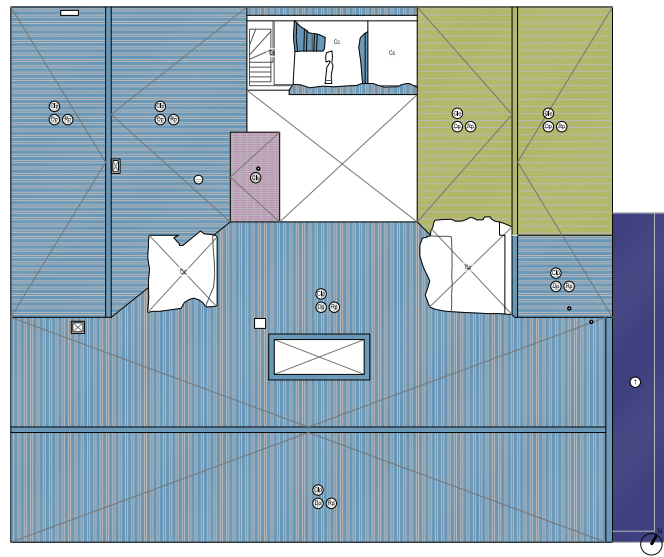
Cubiertas con zonas colapsadas y falta de piezas
